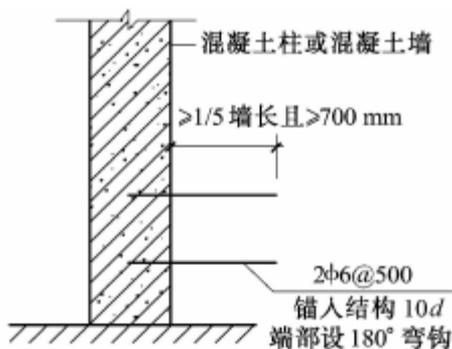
填充墙与钢筋混凝土柱或墙的钢筋拉结
